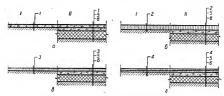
Конструкции полов жилых и гражданских зданий:
